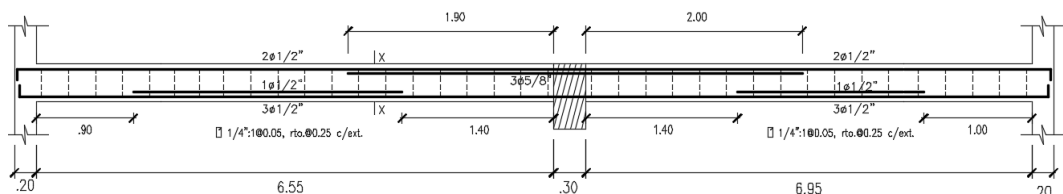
Disposición final de acero en la viga chata VCH-01.
